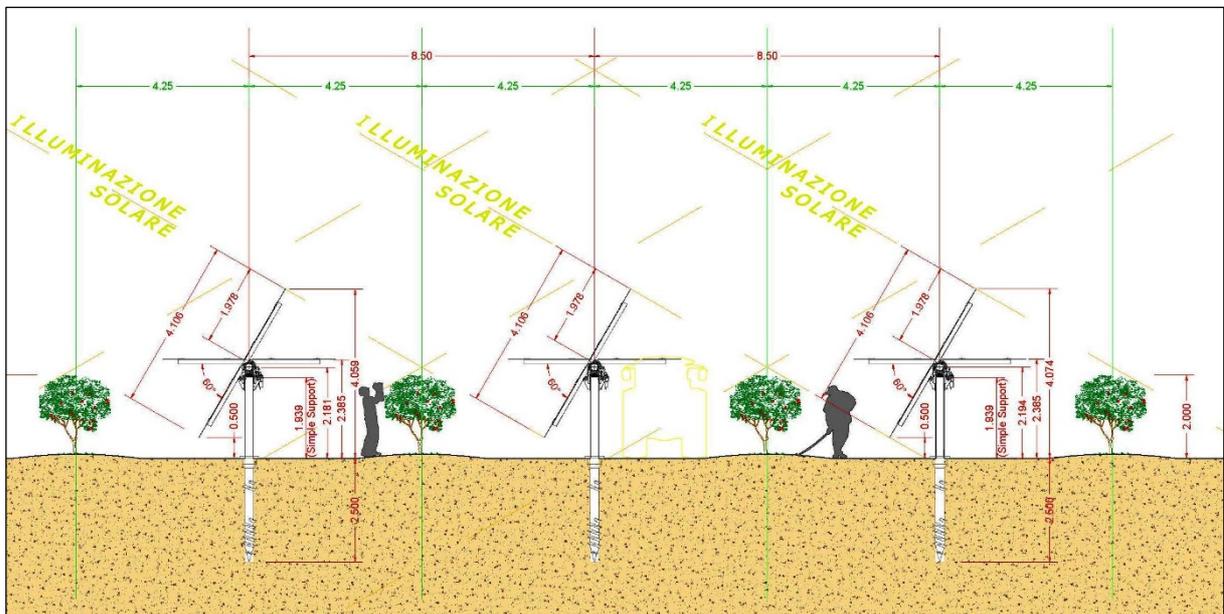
Sezione d'impianto con indicazione delle distanze.
